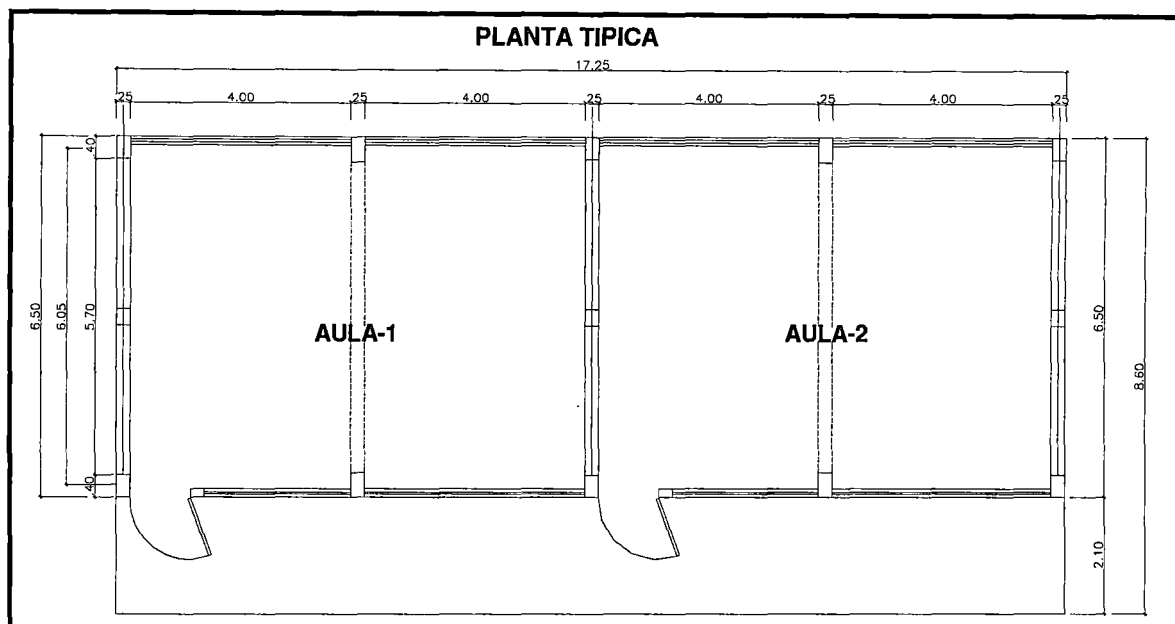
a: Esquema de la planta del módulo Piba-87
